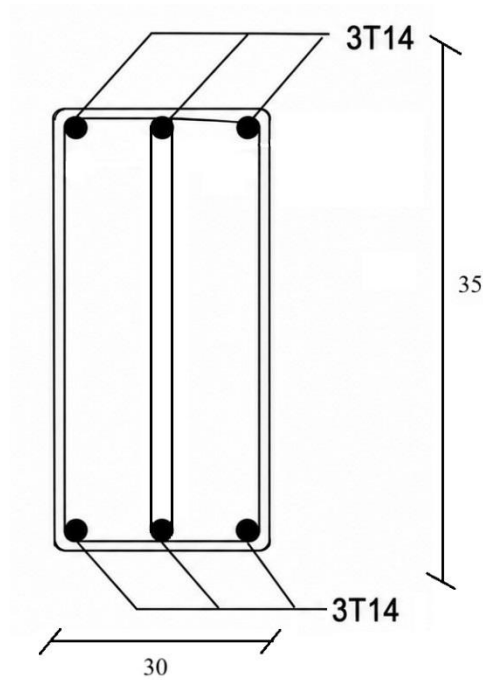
Croquis du ferrailage de la poutre secondaire
